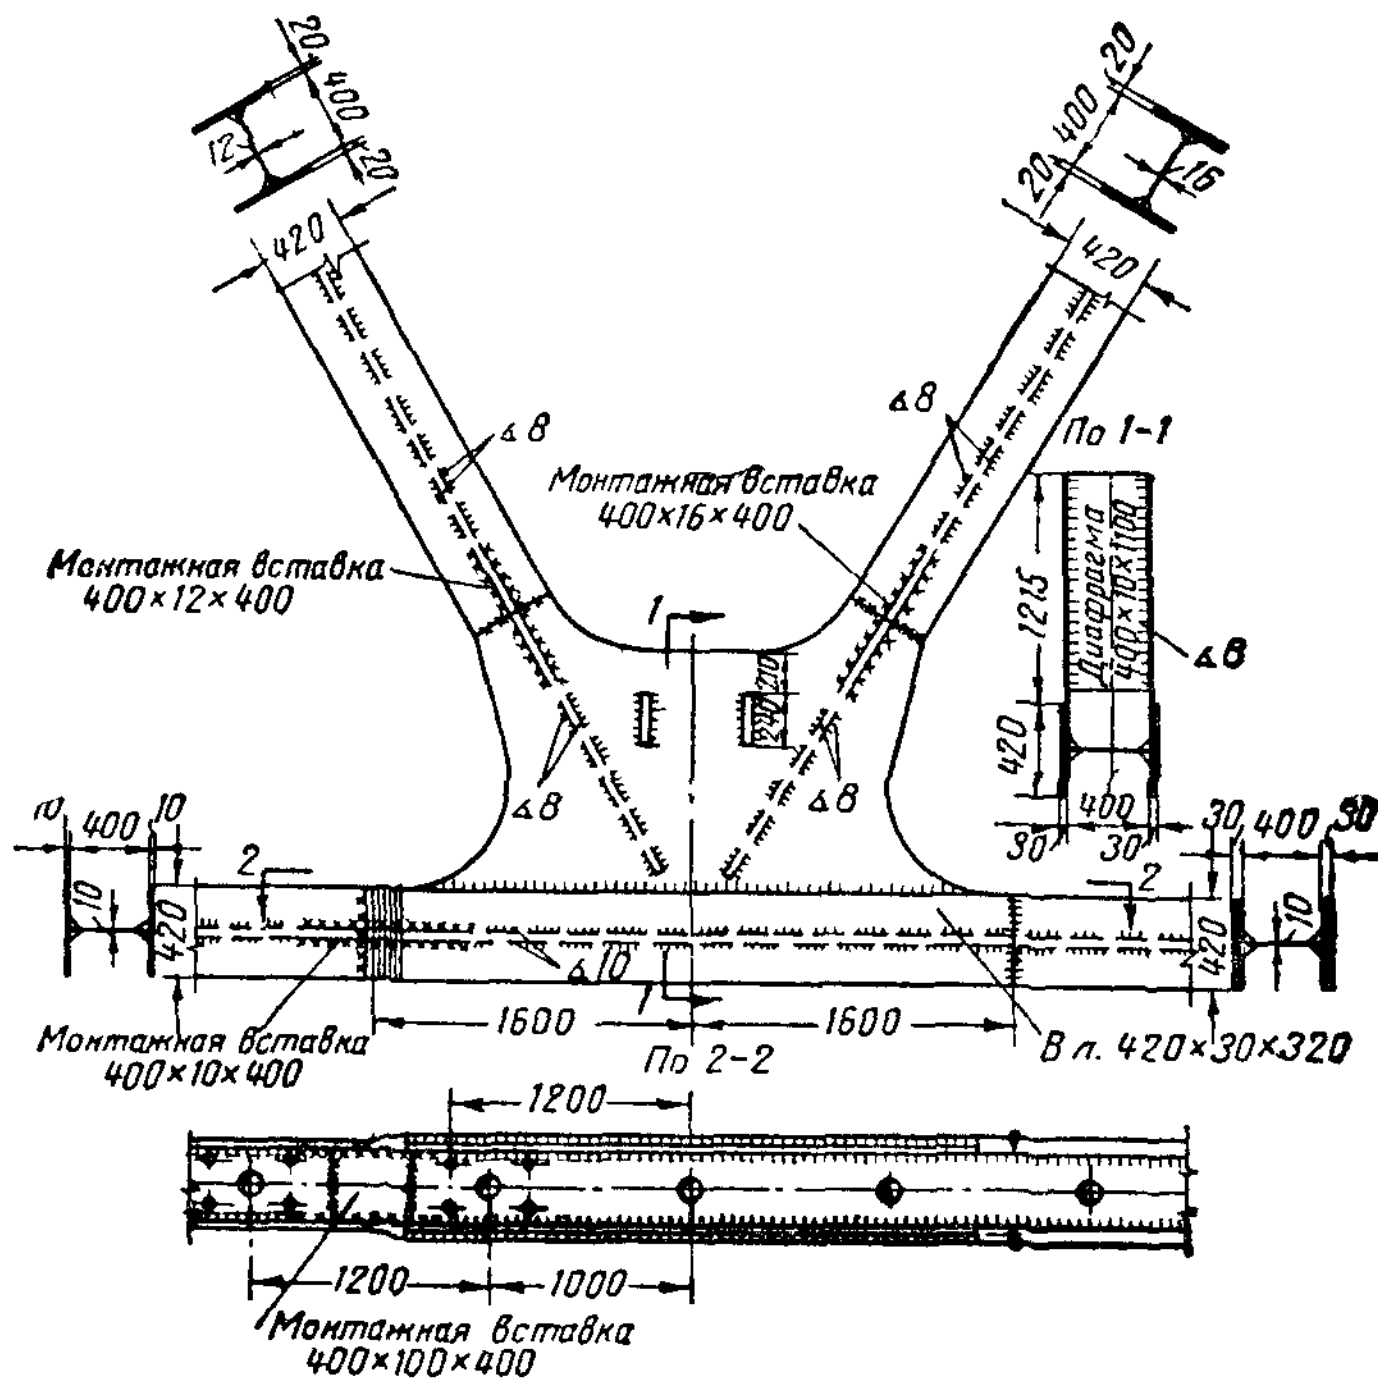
Узел сварной фермы на узловой вставке
